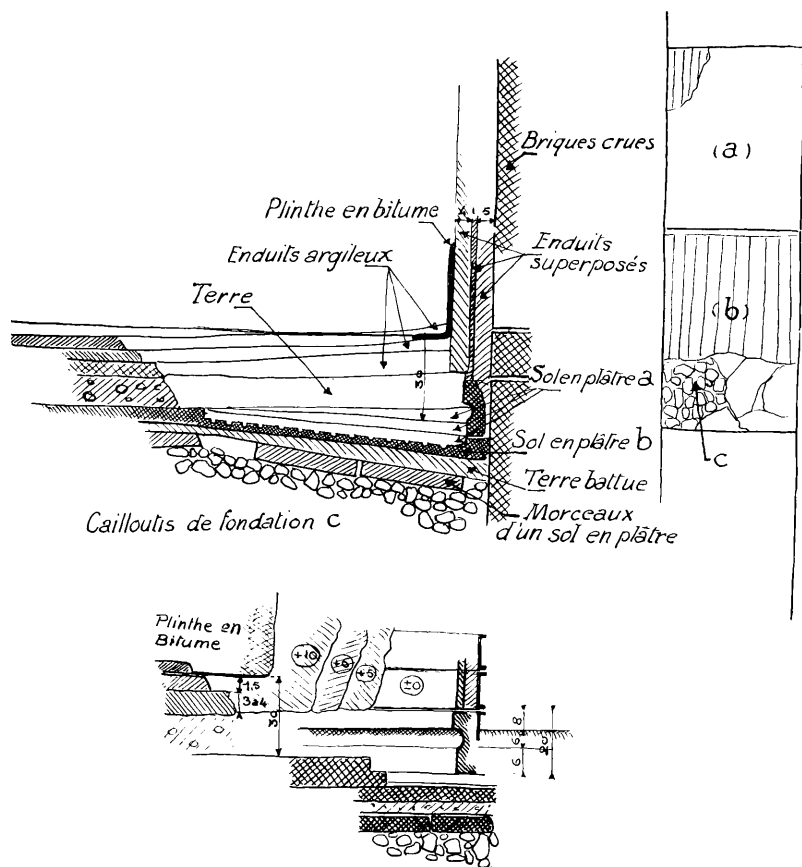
Salle 65. Coupe des différents niveaux du sol.
